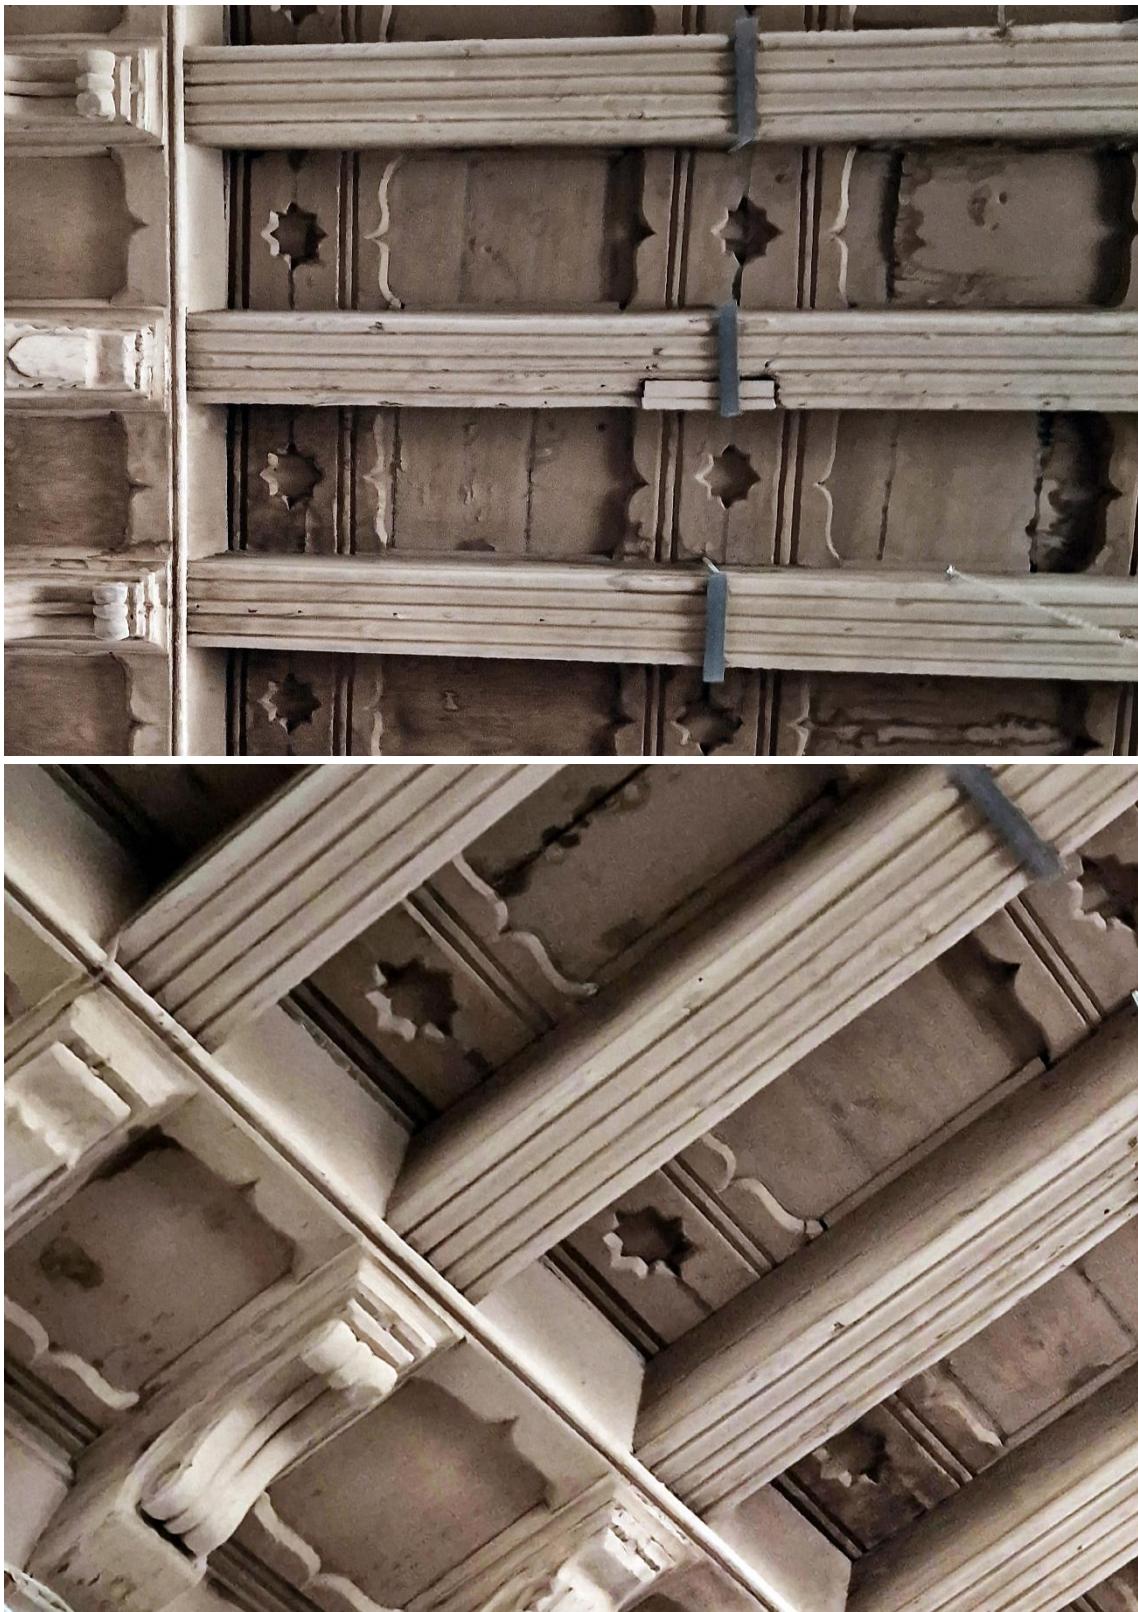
y 4.23: techo plano lignario simple, con un solo orden de vigas (las jávenas, que dan apoyo a las tablazones). Hay añadida una relevante viga maestra central de madera, apoyada en dobles canecillos lignarios sobre columnas. La viga maestra divide al techo en secciones. Coro Bajo de la Iglesia de *Las Puras* (Almería). Capturas del 28 (imagen superior) y del 27 (imagen inferior) de noviembre de 2023.
